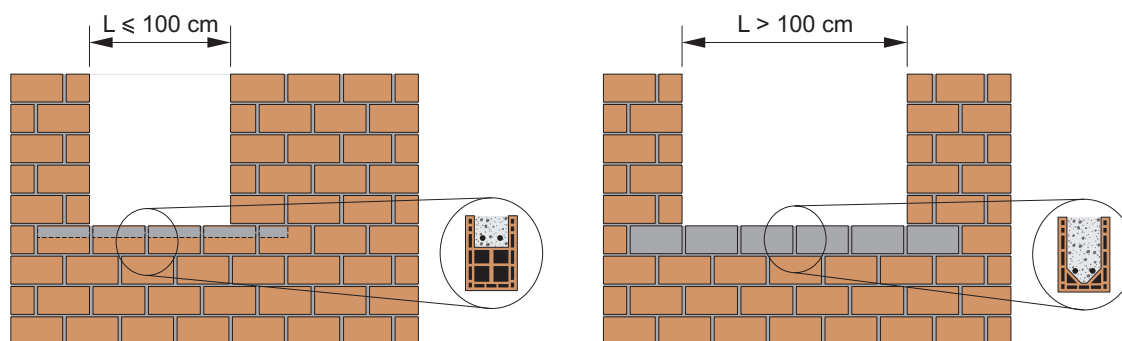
Contravergas com blocos seccionáveis ou blocos tipo canaleta.
